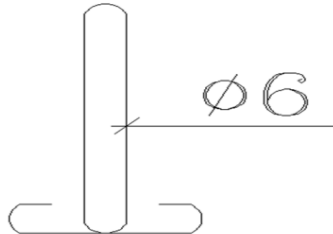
schéma de Ferrailages Étriers de la poutelle.
